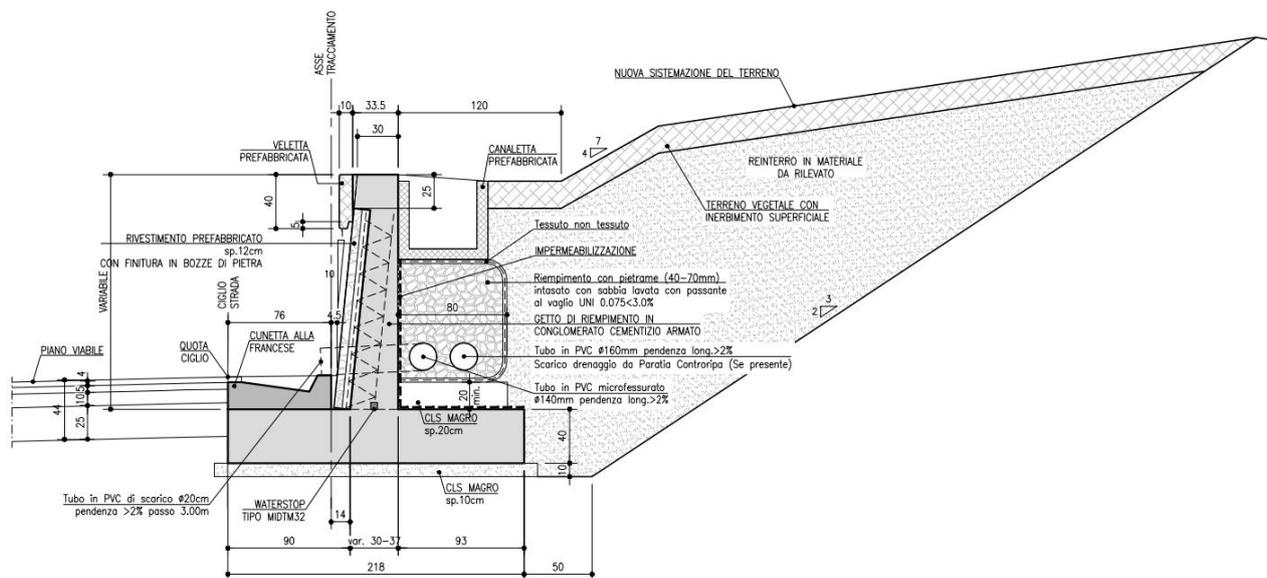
Sezione tipo Muro di controripa rivestito
